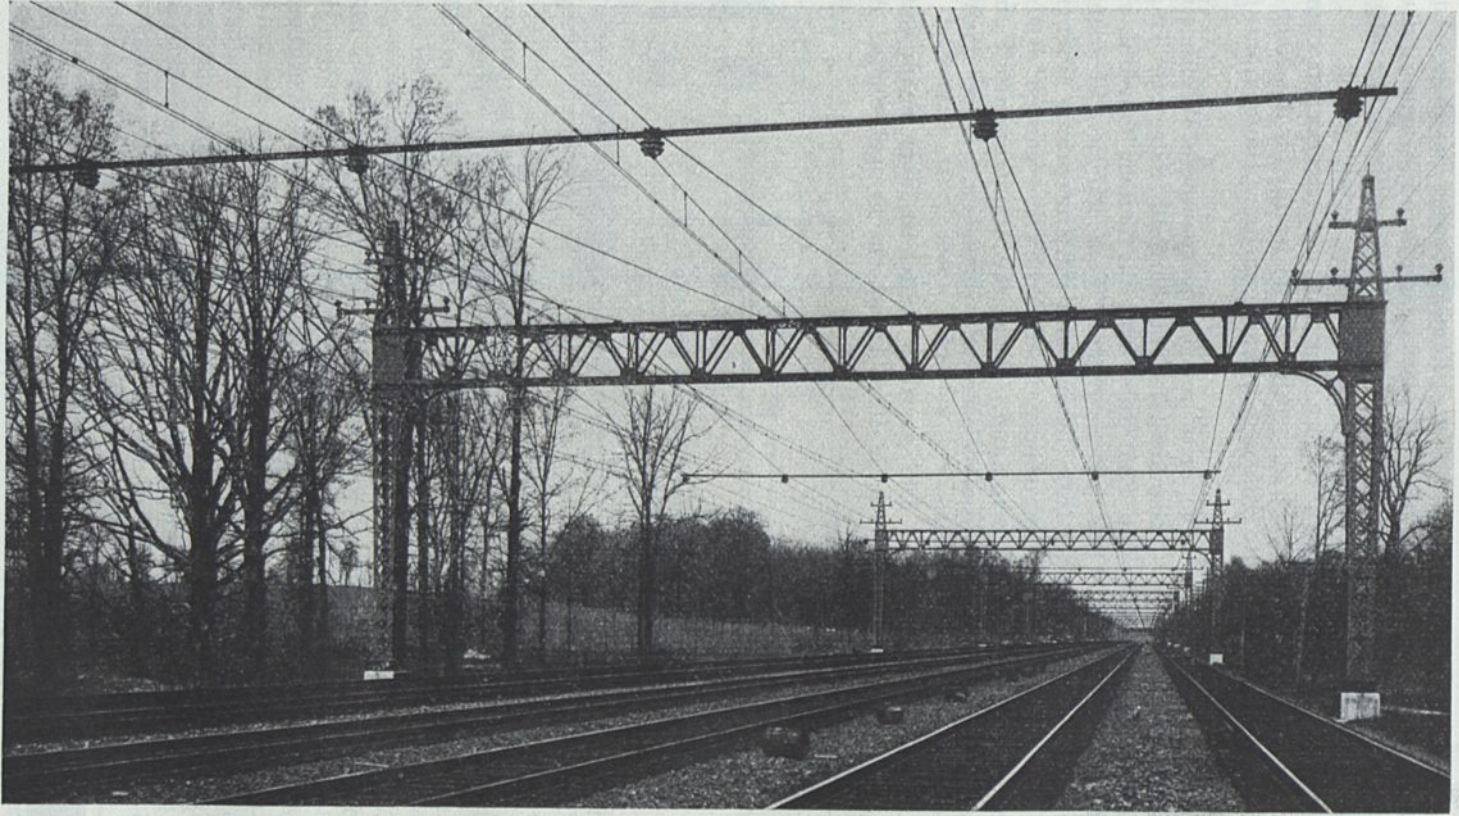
Fahrleitung mit Verbundkettenwerk der New Haven-Bahn.
